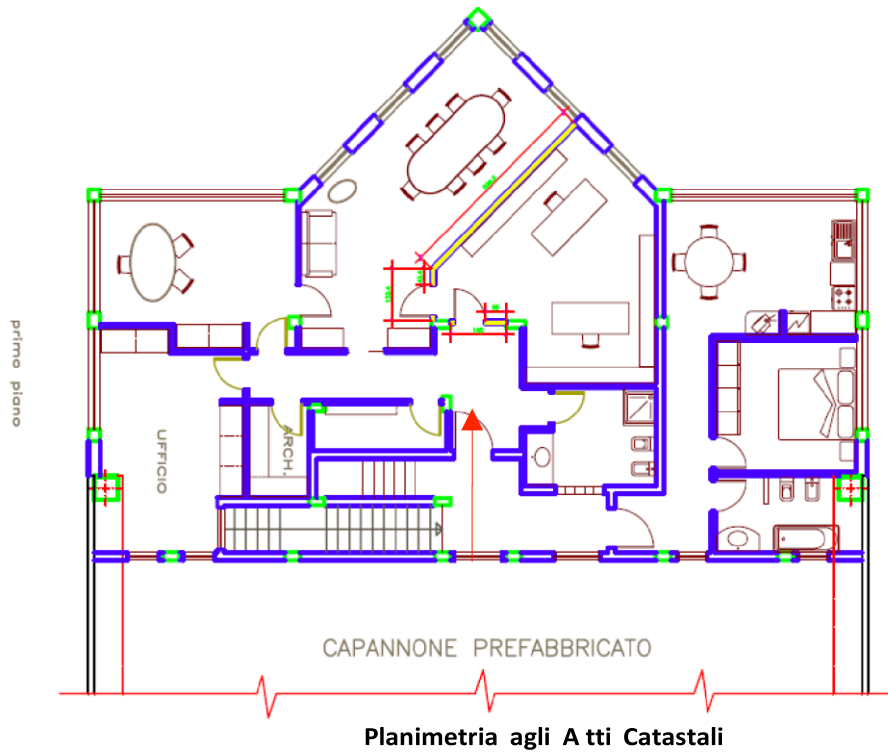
Confronto tra la planimetria catastale e quella rilevata (Allegato 11)
